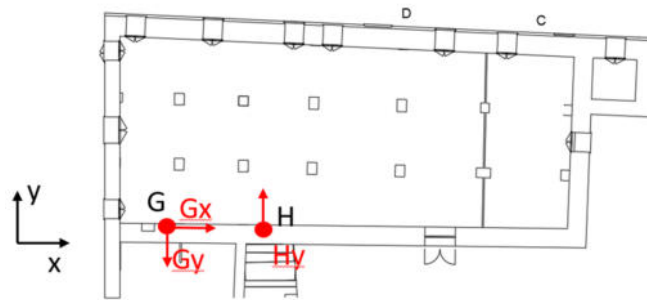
Disposizione accelerometri nel piano terra dell'edificio.
